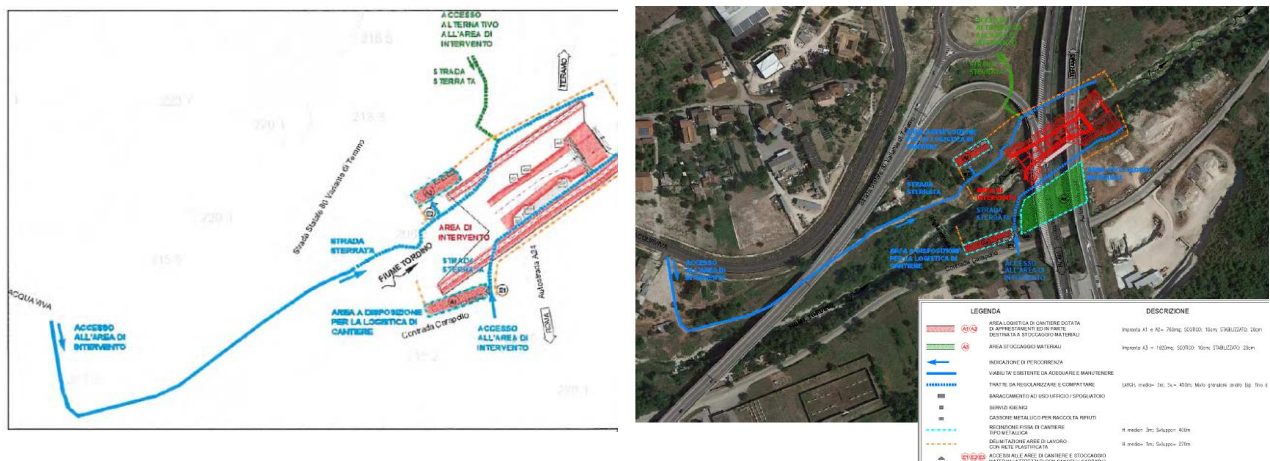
Planimetria di cantiere di progetto definitivo e esecutivo per gli interventi in corrispondenza del viadotto
